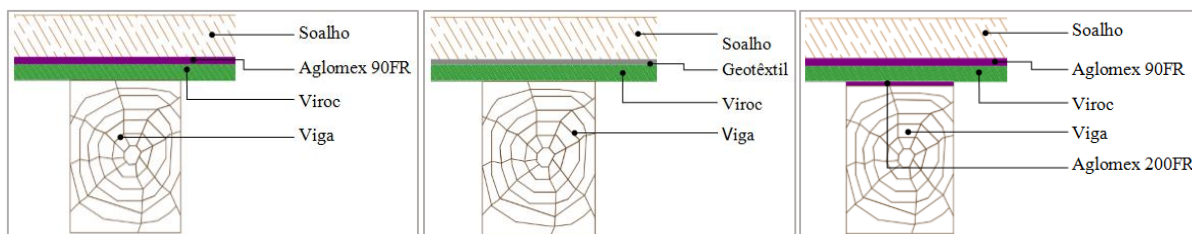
Esquemas das três soluções de reabilitação de pavimentos sem teto (solução 1, 2 e 3)
